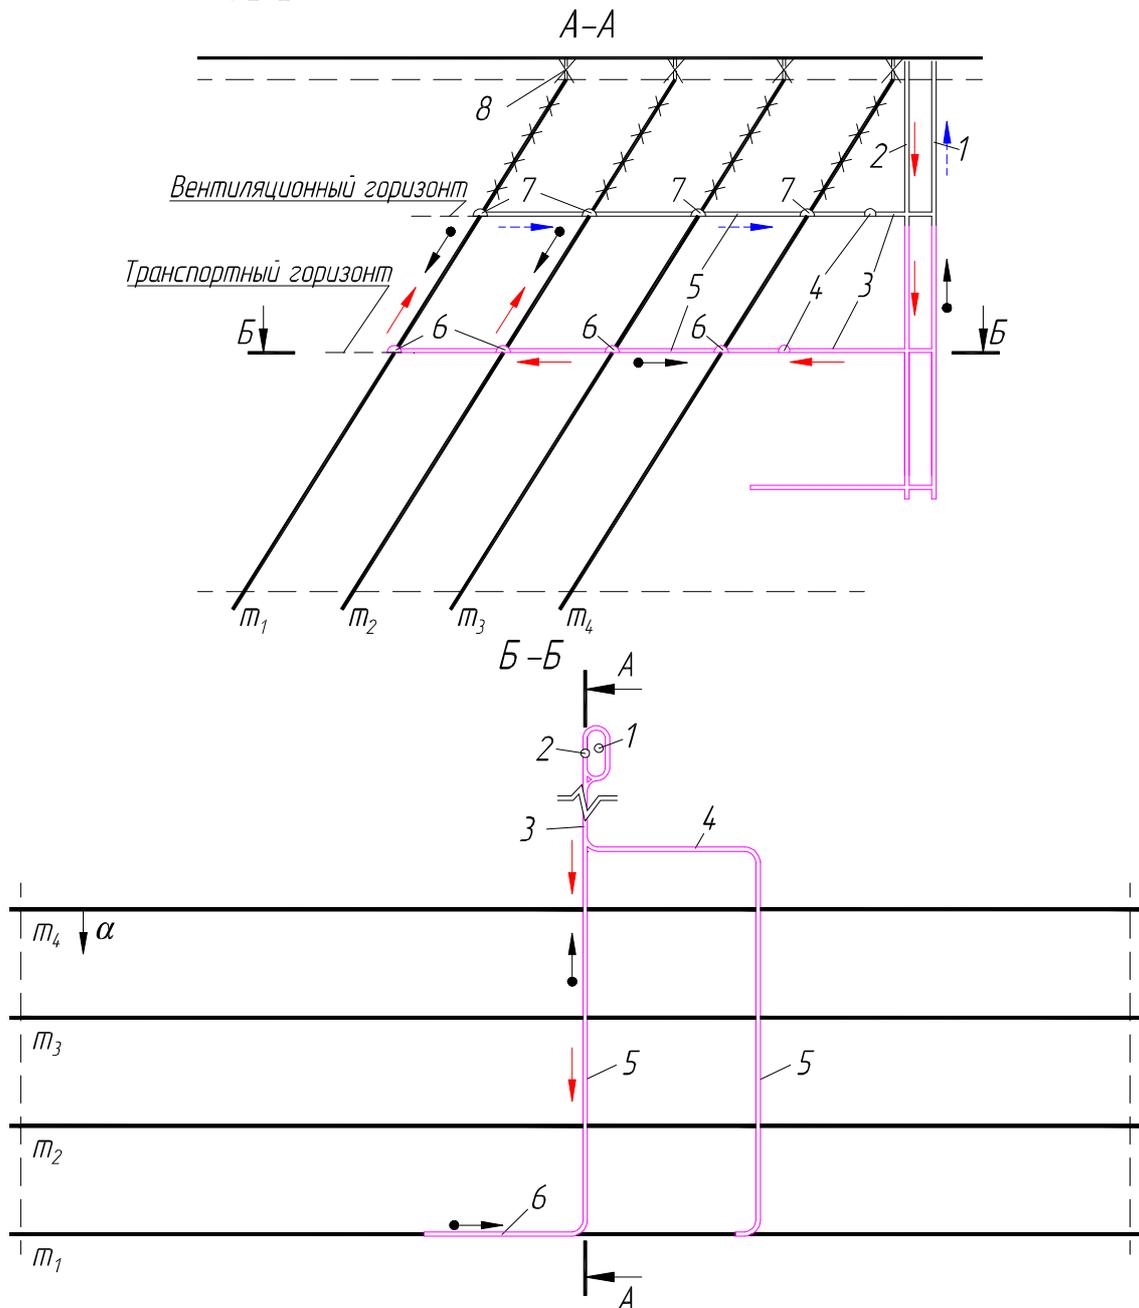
Схема вскрытия вертикальными стволами с этажными квершлагами:
